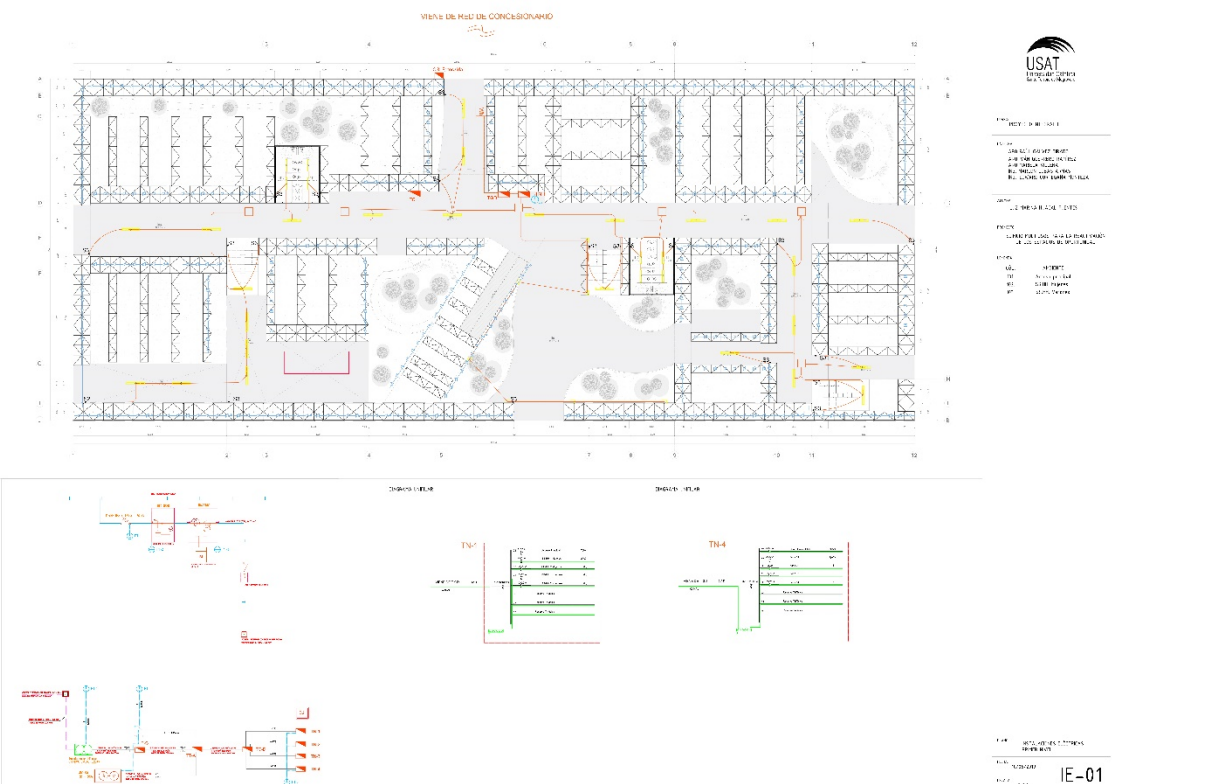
Instalaciones eléctricas primer nivel. Fuente: Elaboración propia
